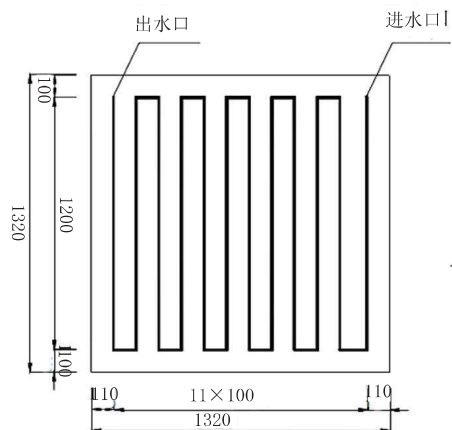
承台一、三、五层冷却管平面布置图(单位:cm)
